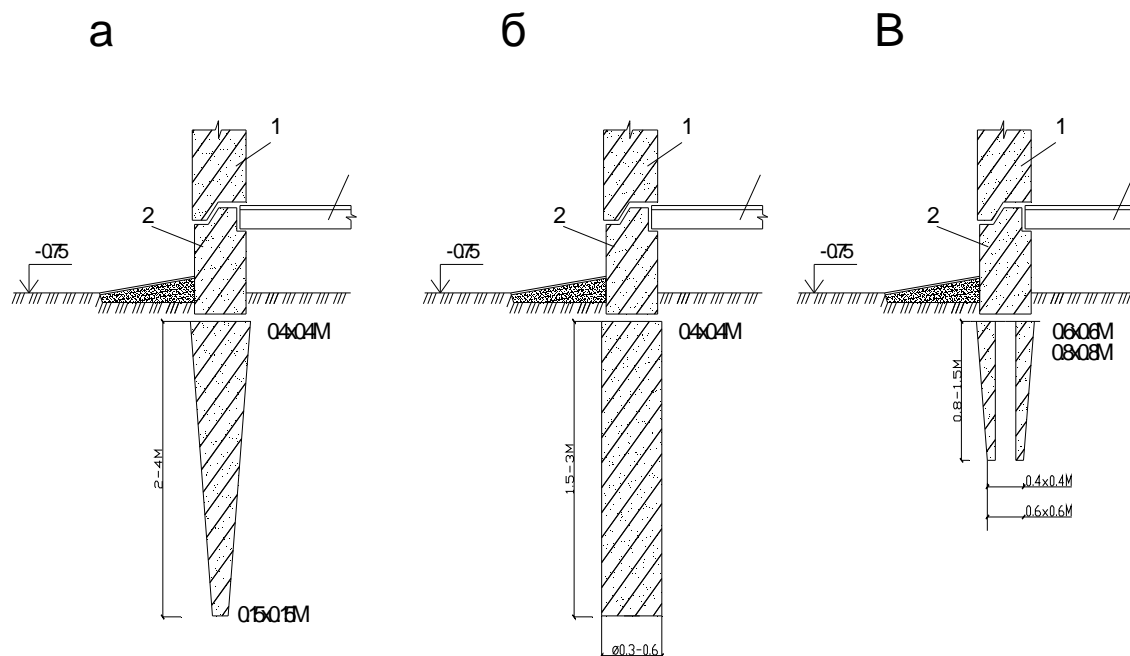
Безростверковые фундаменты усадебных домов:
